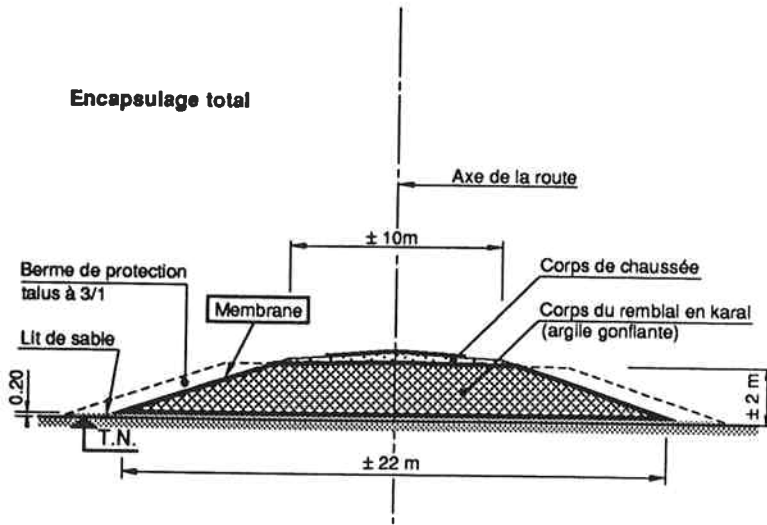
Encapsulage de remblai au Nord-Cameroun
